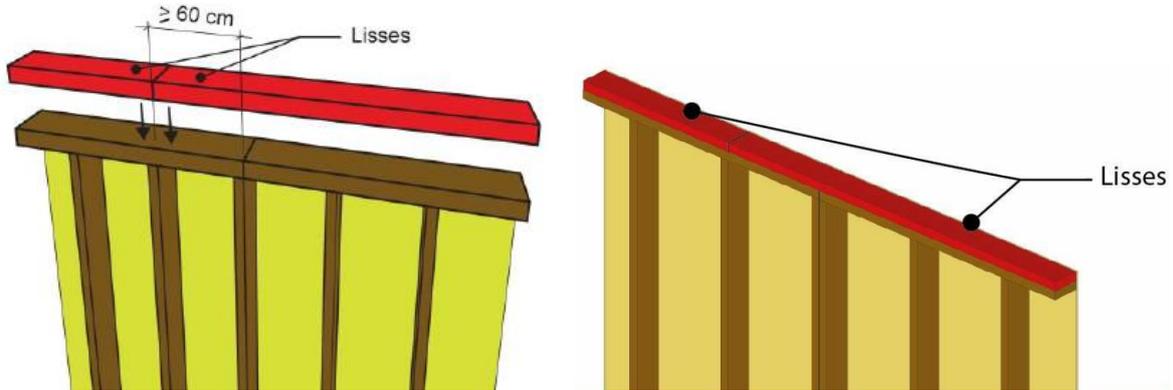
Exemple de mise en œuvre de la lisse haute sur des parois dans le même plan
